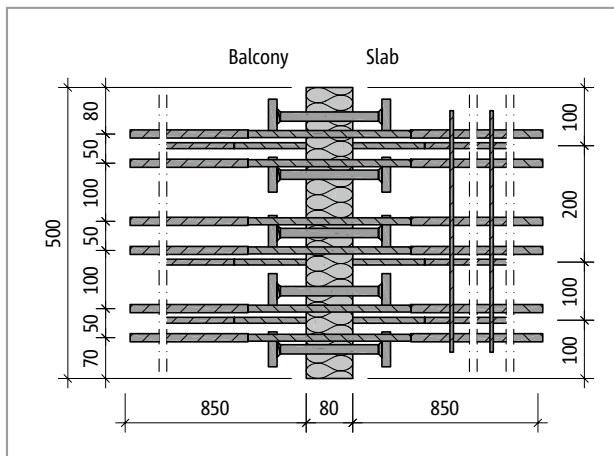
Schöck Isokorb® T type K-M12-V1: Product layout
